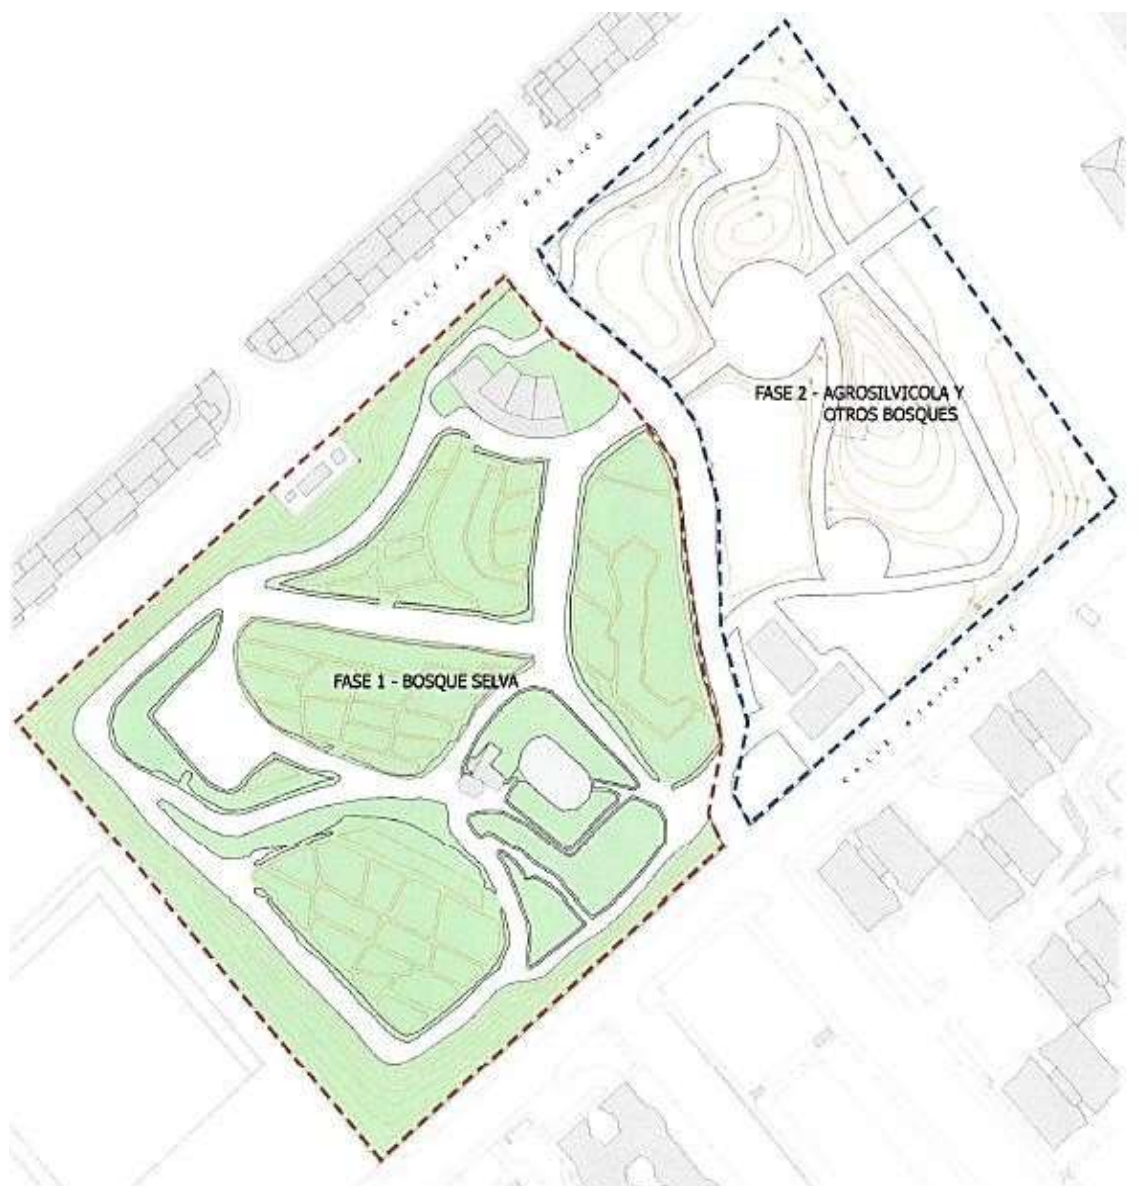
Plano de diseño de la Fase I y la Fase II. Fuente: Ayuntamiento de Adeje
